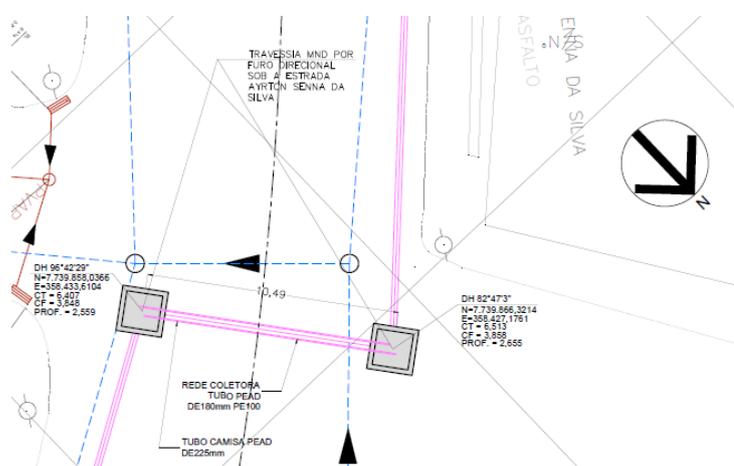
Planta de localização da travessia SB-T05 – LR-EEEEB-T03
